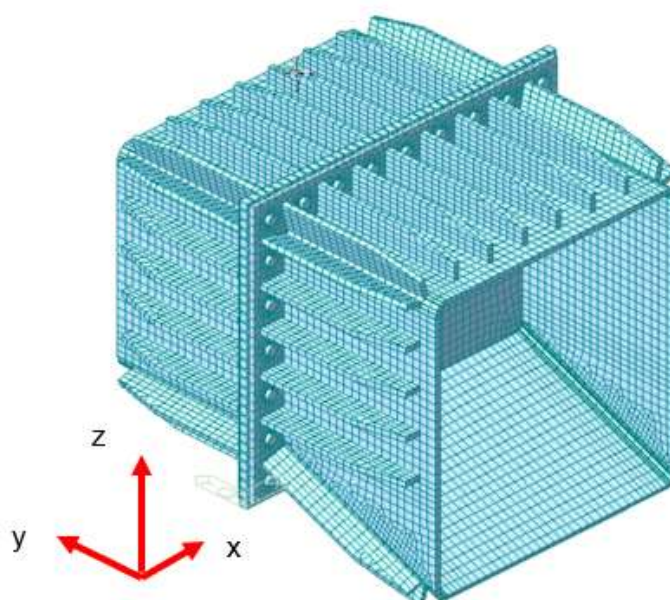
Sistema di riferimento Nodal Loads collegamento sbraccio
